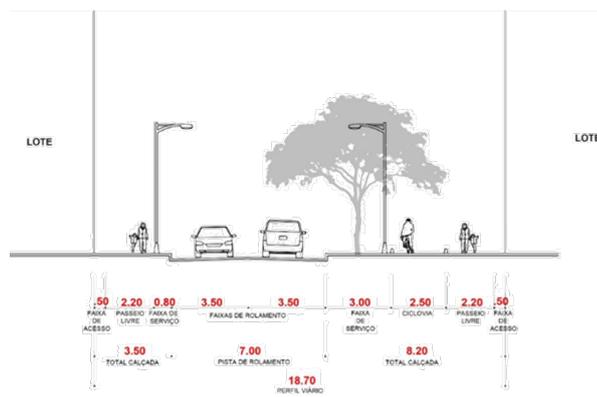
Perfil da Rua Cabo Frio e da Rua Delft
